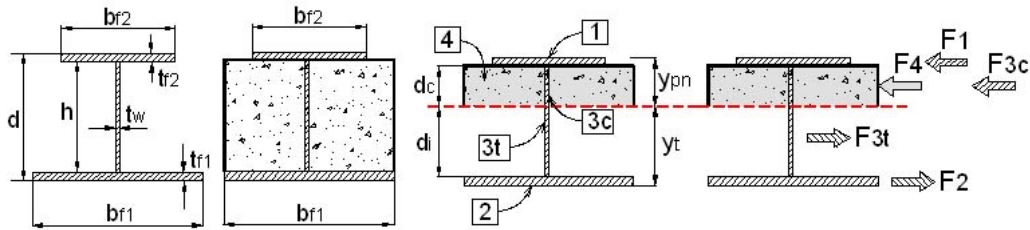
Geometria da viga mista revestida. (Fonte: DE NARDIN; EL DEBS, 2007).
